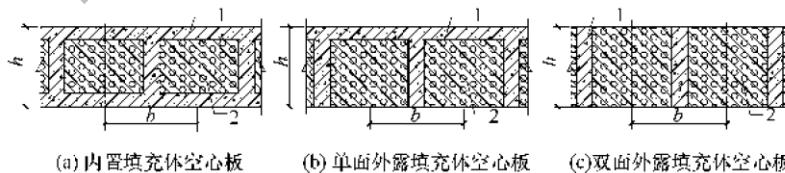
现浇混凝土空心楼板截面示意图
